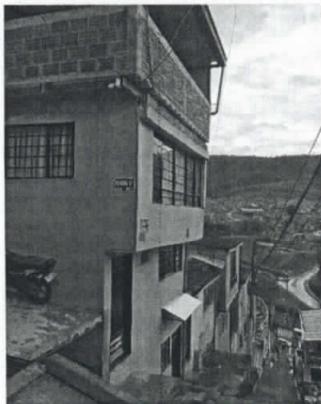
Estado actual del predio ubicado en la Calle 48J No.8C-68.
